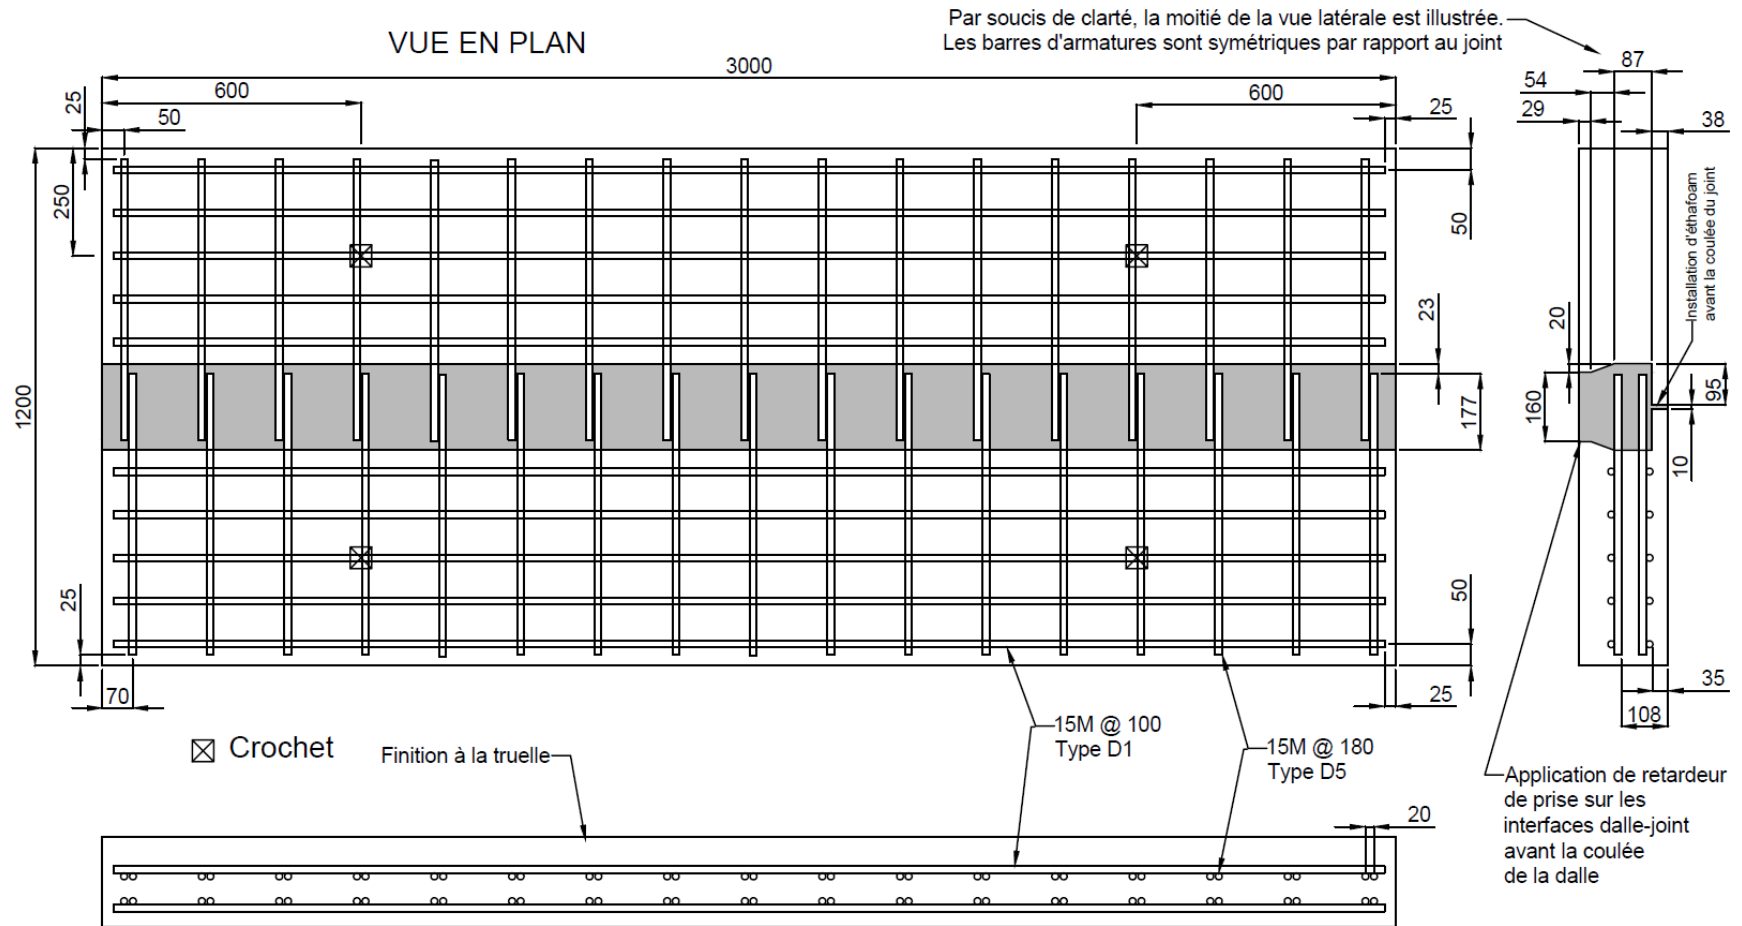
Dalle en BHP avec joint de connexion transversale (TQC) pour le test statique (#2.1)
